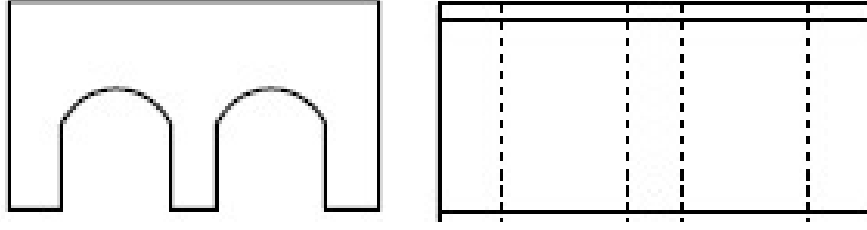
Millet Köprüsü Üst Görünüm Planı
